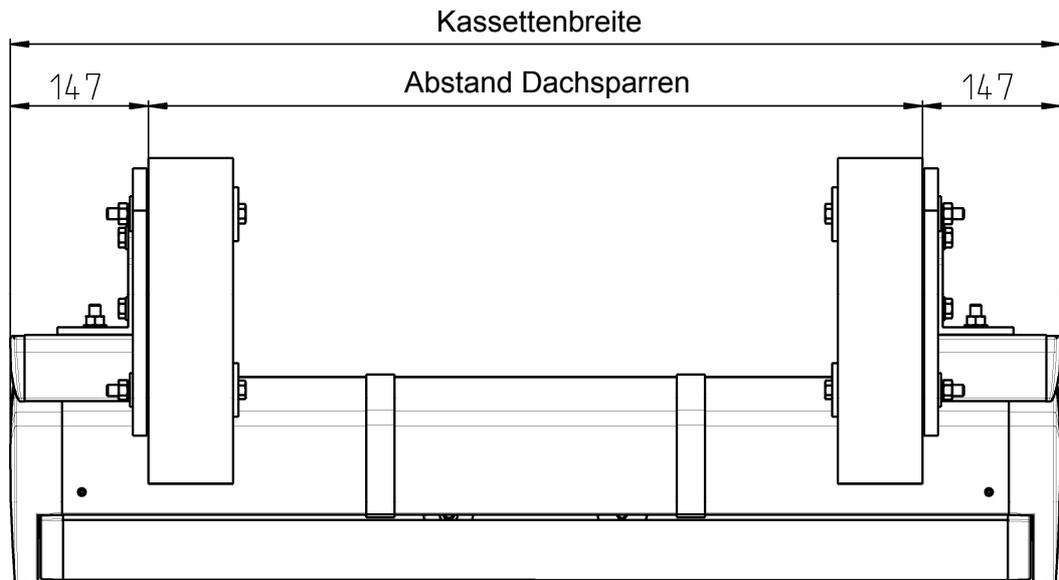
Standard Dachsparrenbefestigung mit Dachsparrenhalter und Montageplatte
